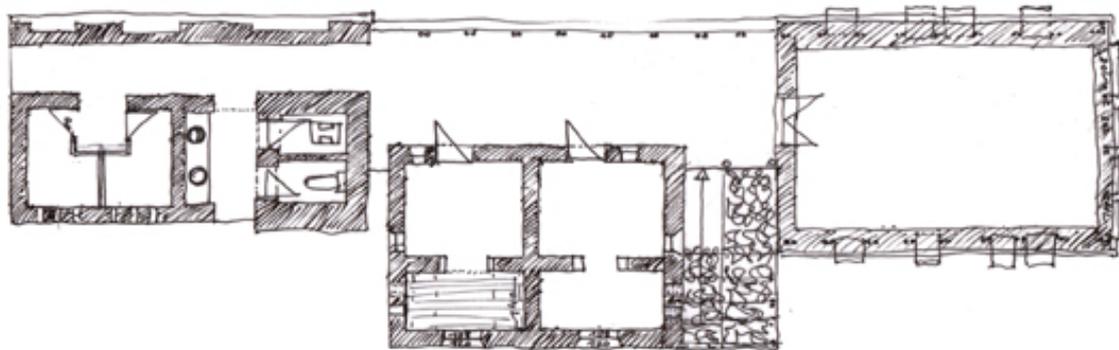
Boceto de la planta baja. Desde las primeras intenciones proyectuales, se piensa en los elementos de ventilación, así como en el sistema constructivo.
